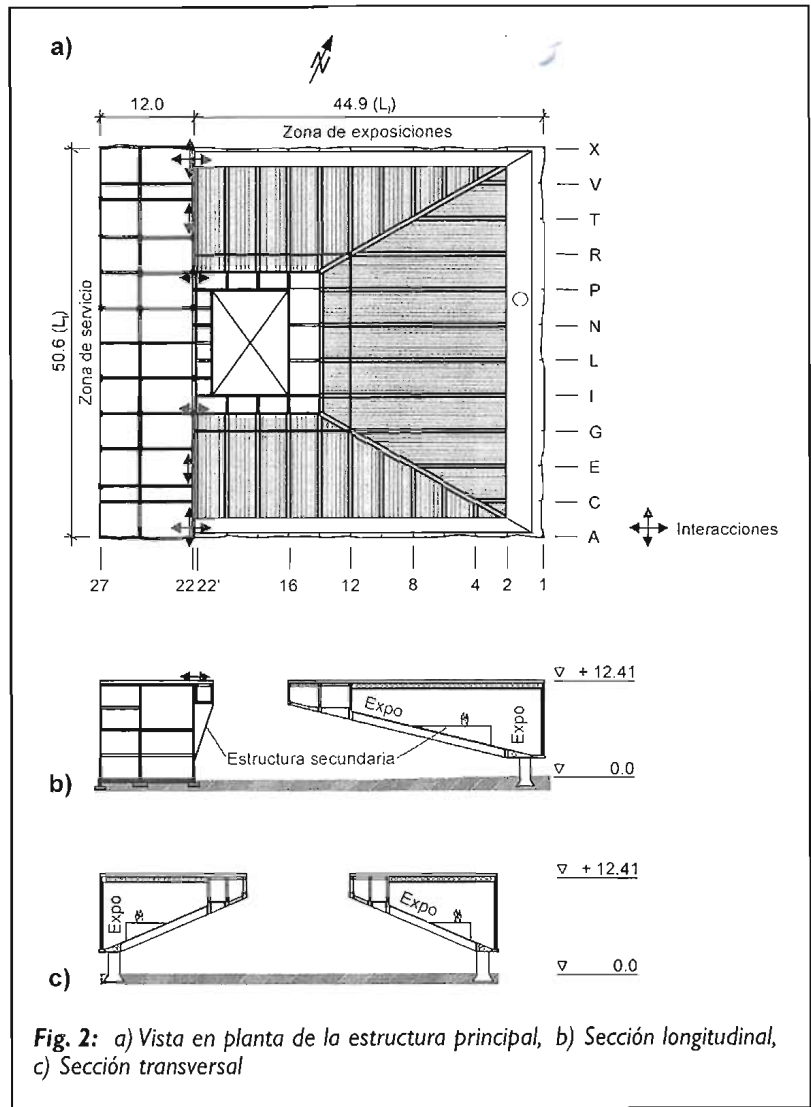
a) Vista en planta de la estructura principal, b) Sección longitudinal, c) Sección transversal
